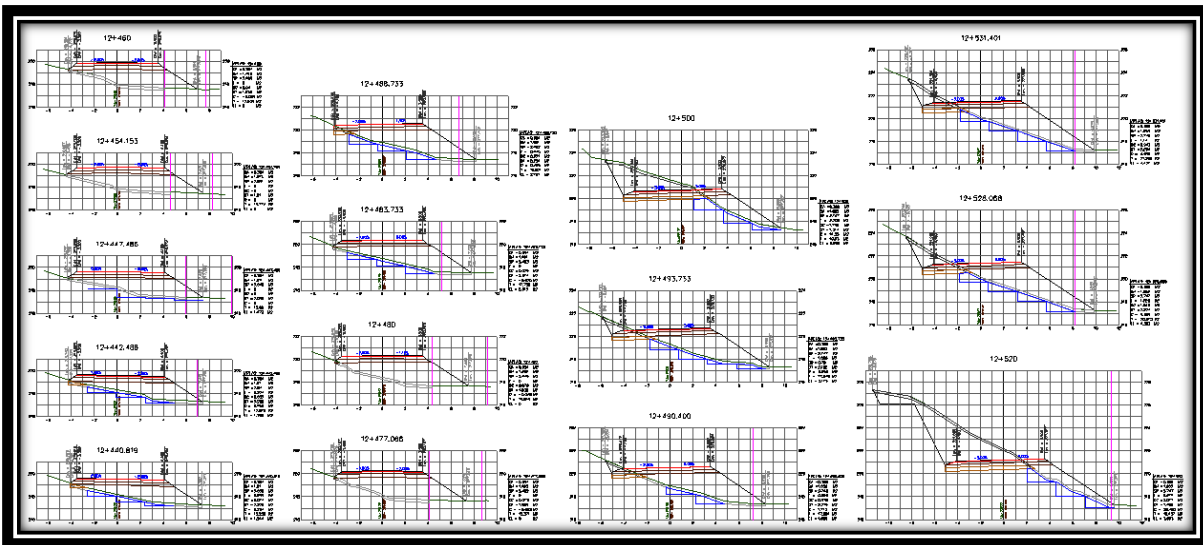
Secciones de construcción del km 12+440.819 al km 12+531.401.
